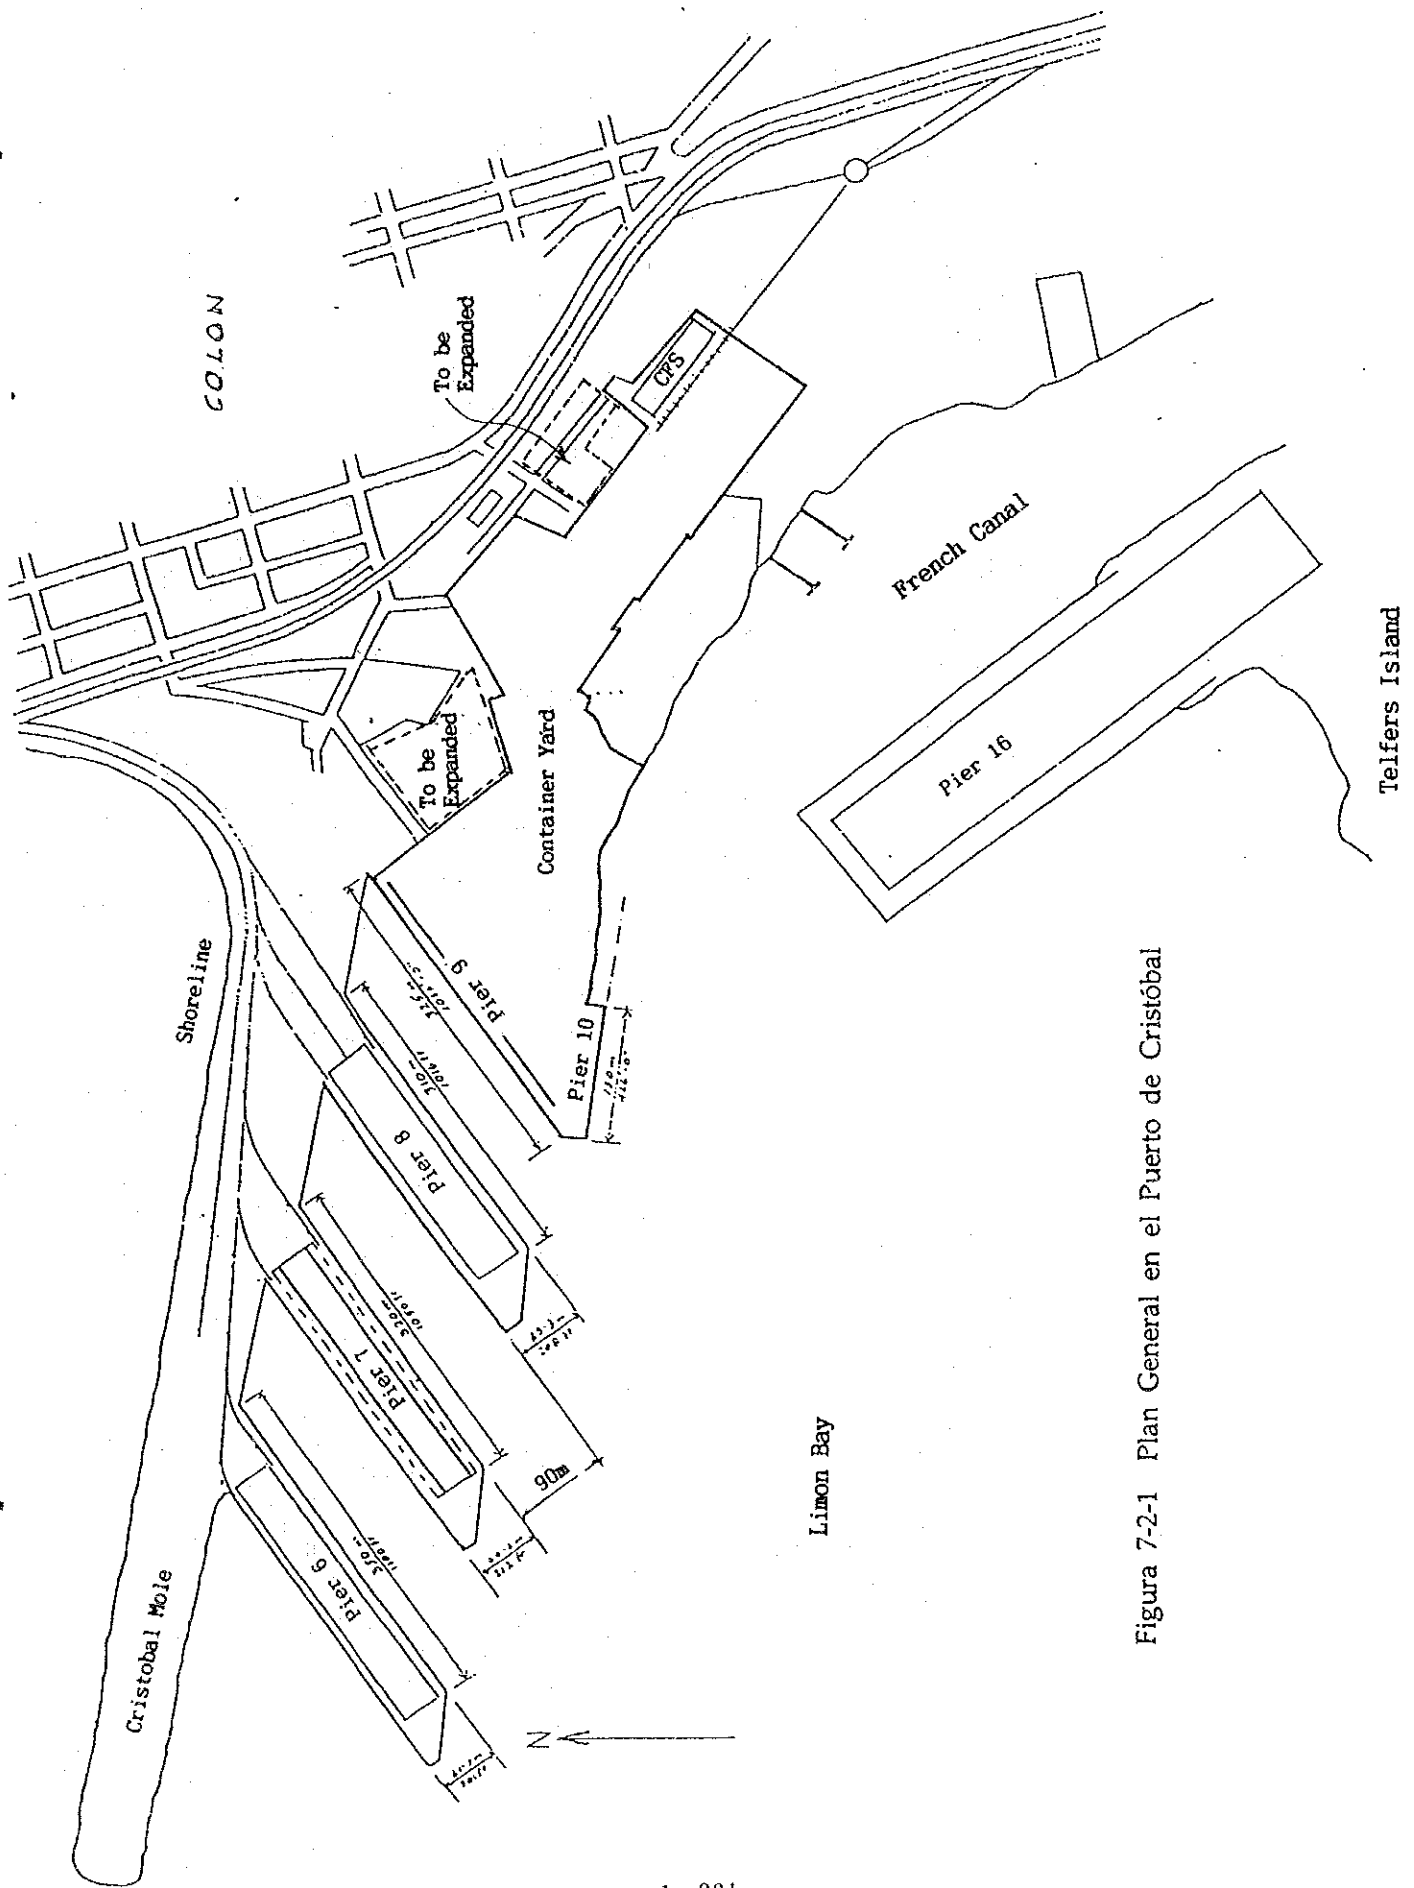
Plan General en el Puerto de Cristóbal
